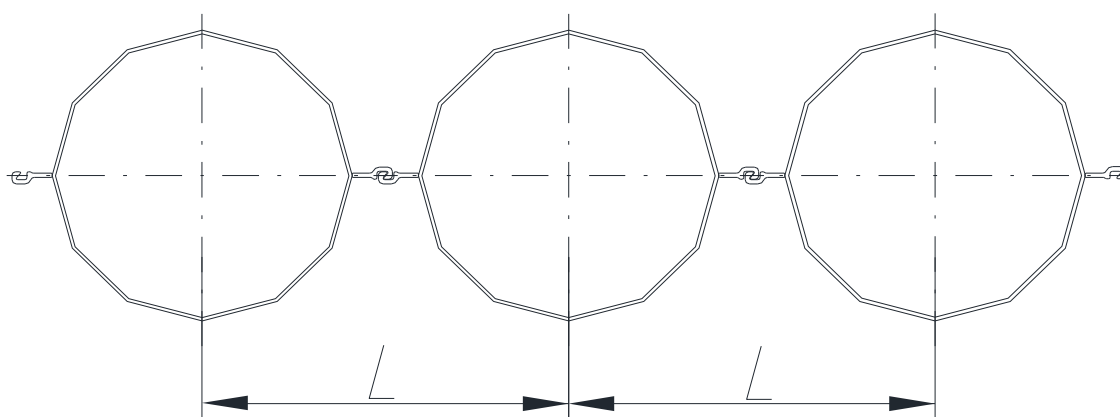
Поперечное сечение стены из шпунта ТСС с замковым профилем LPB180
